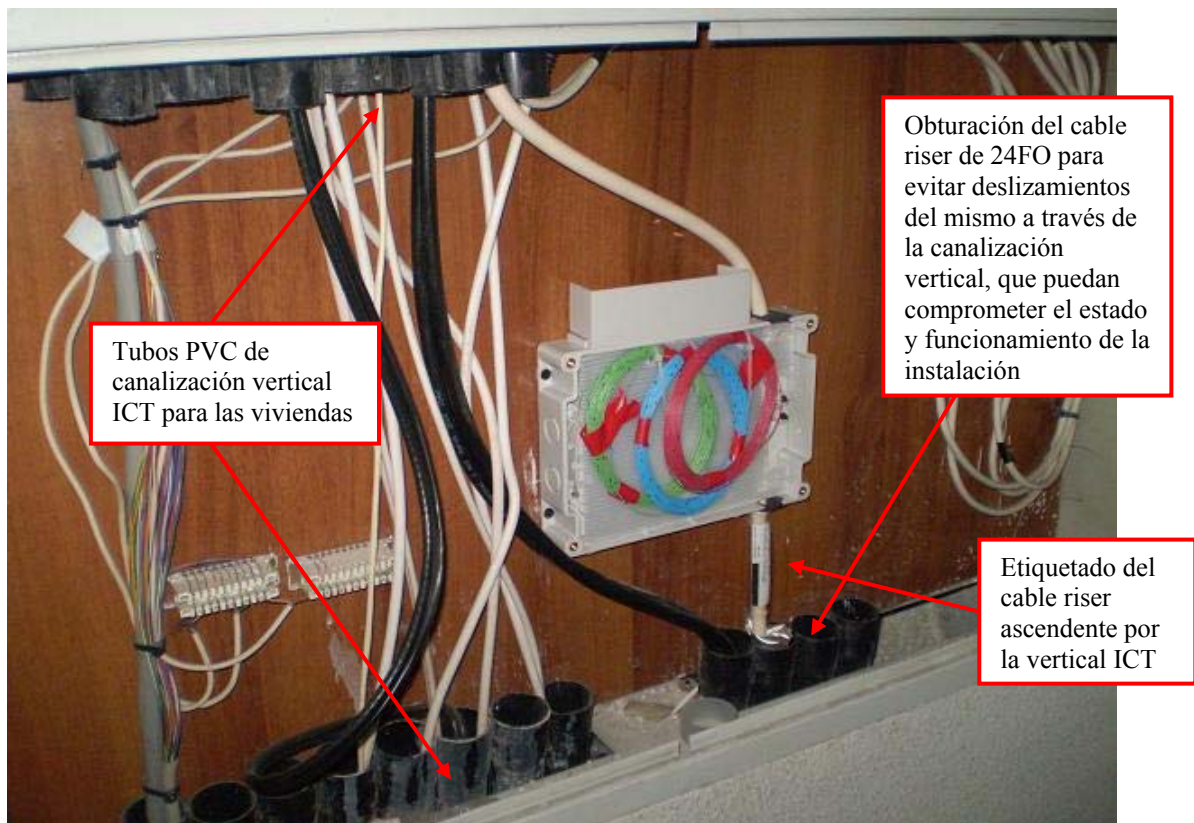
Vista exterior de caja Riser Box Verticasa, de derivación de planta 1ª
